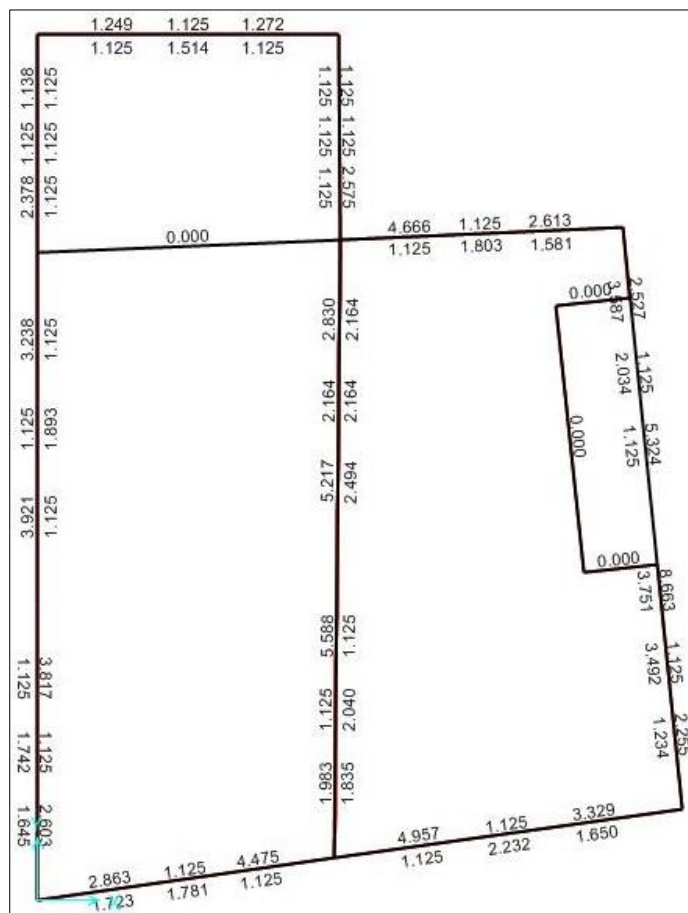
Armadura longitudinal nas vigas (piso 01)
